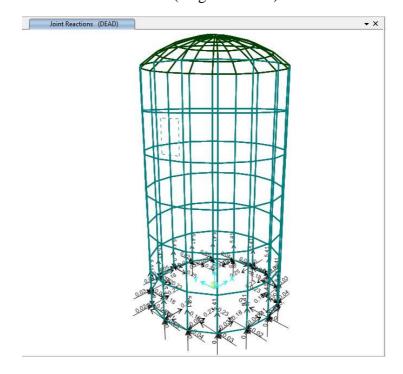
Fuerzas que actúan sobre las restricciones (cargas hidrostáticas)
